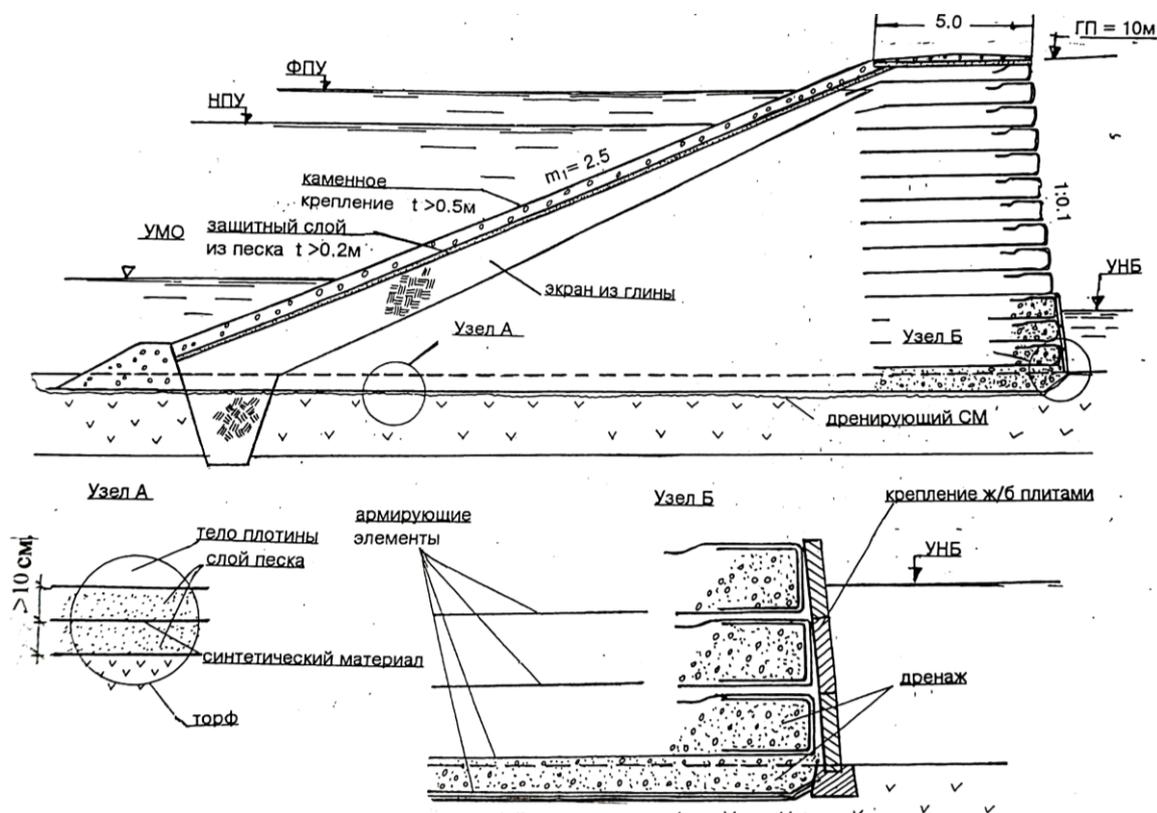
Земляная насыпная переливная плотина из армированного грунта высотой до 10 м, ТП В/О Союзводпроект, 1987 г.
